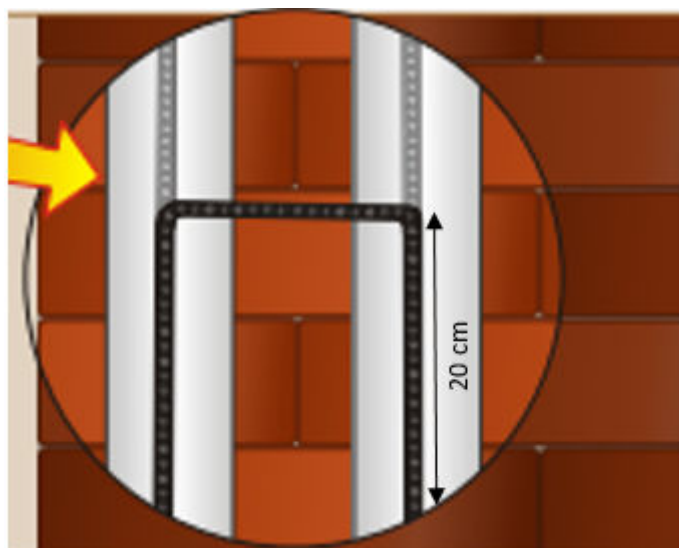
Corte transversal detalhando a instalação do grampo estrutural
